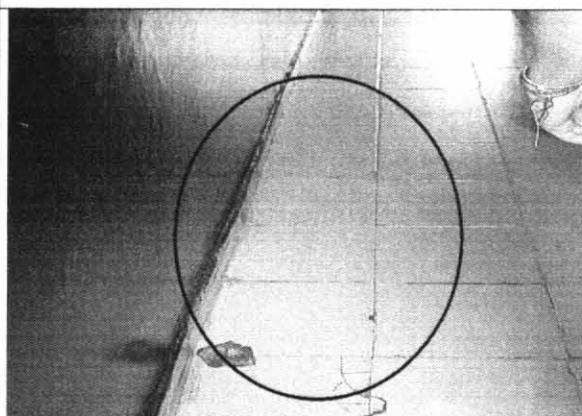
A nivel de piso dos (2) se evidenció que la placa de entrepiso ha sido reparada superficialmente debido a fisuras y agrietamientos presentadas en la misma.
